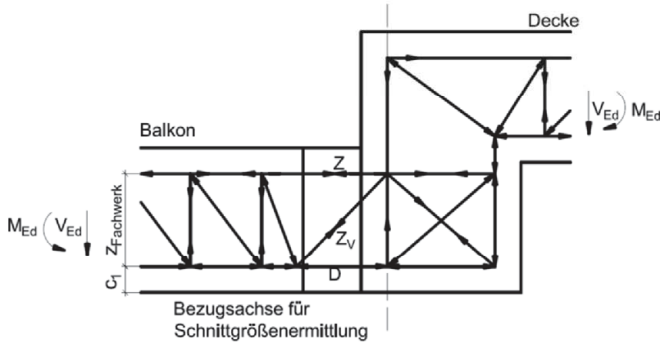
Schöck Isokorb® Typ K-U und K-U-F mit Anschluss an Höhenversatz
